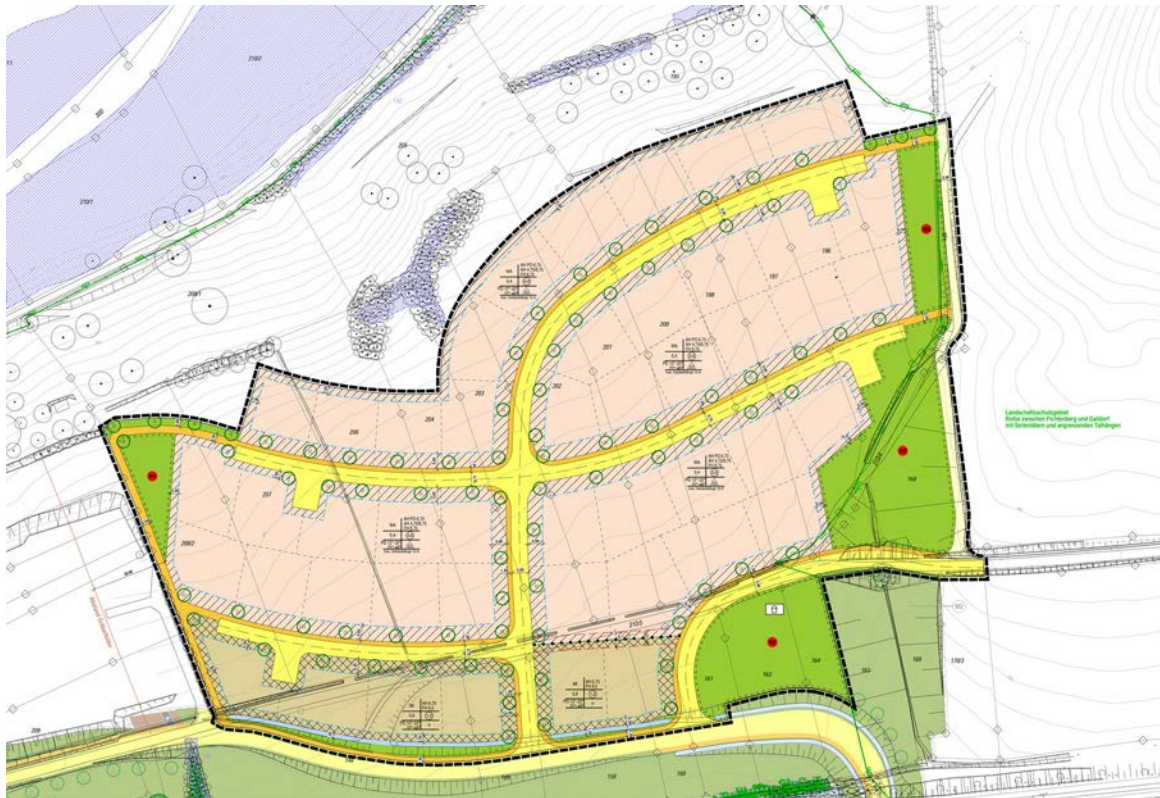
rechtsgültiger Bebauungsplan „Auchthalde“, ohne Maßstab
